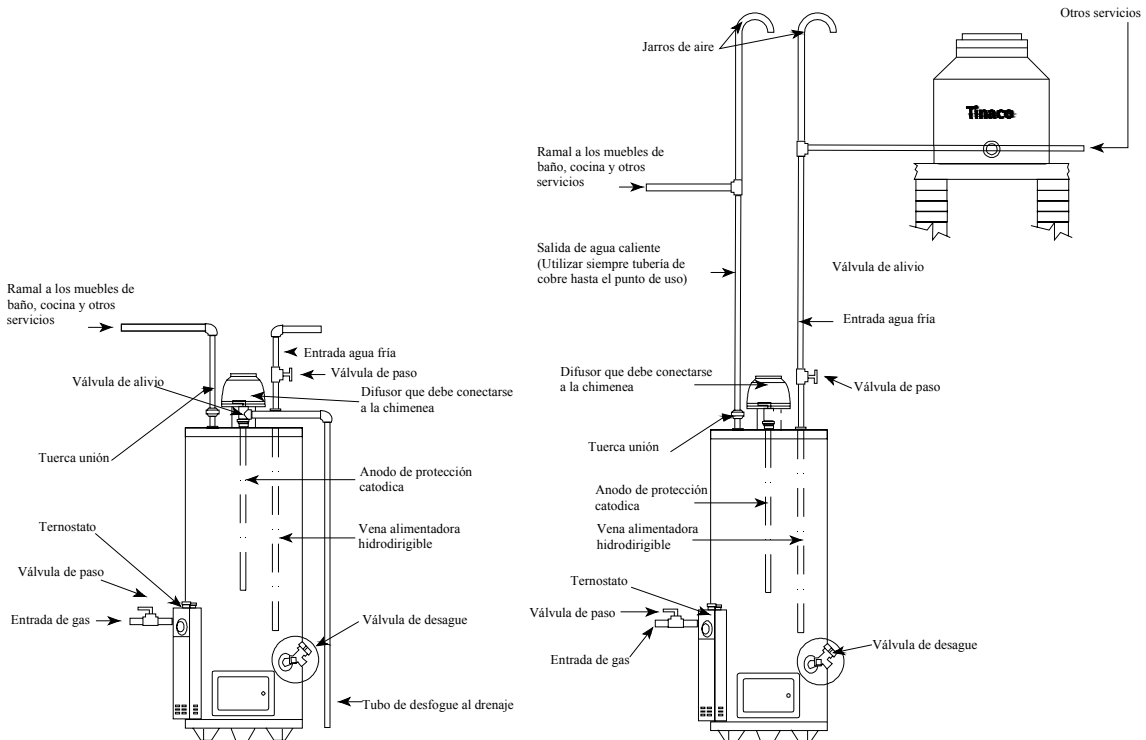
Instalación de un calentador de depósito: del lado izquierdo sistema abierto y del lado derecho sistema cerrado.
